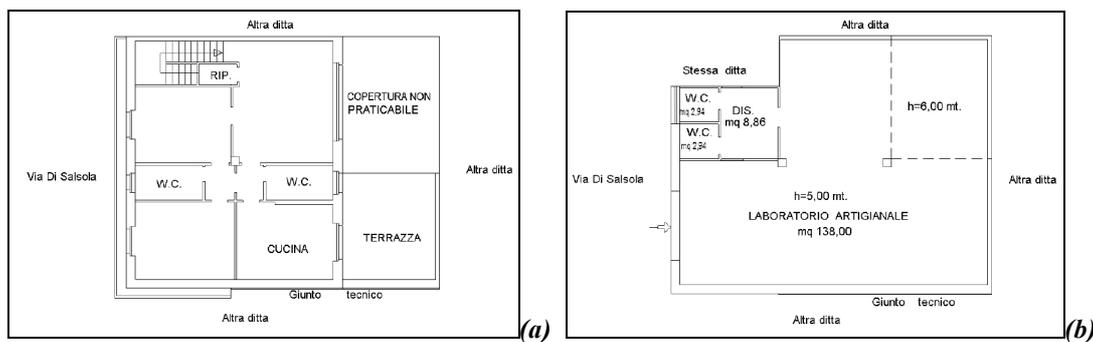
Planimetrie catastali degli immobili ubicati in via Di Salsola n° 149 e n° 149/A: abitazione in primo piano (a); locale a pianterreno (b).
